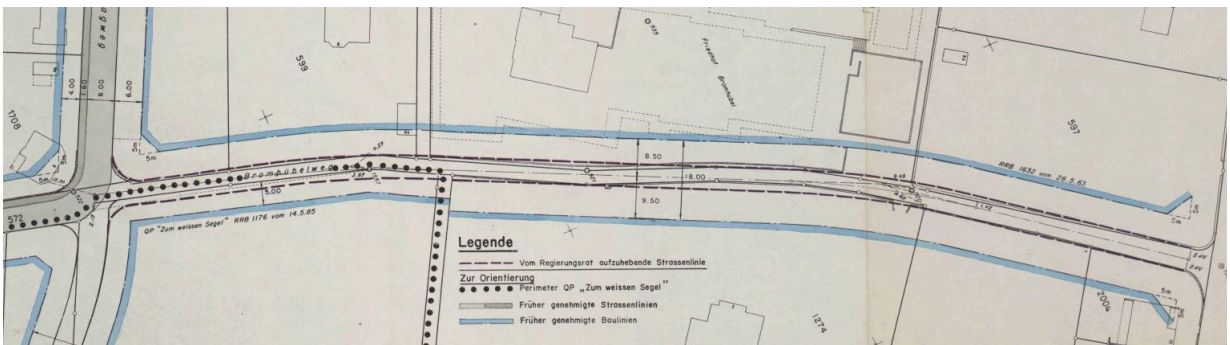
Ausschnitt Bau- und Strassenlinienplan Bromhübelweg (06/eBS/16/02) von 1986 (Quelle: Gemeinde Arlesheim)
